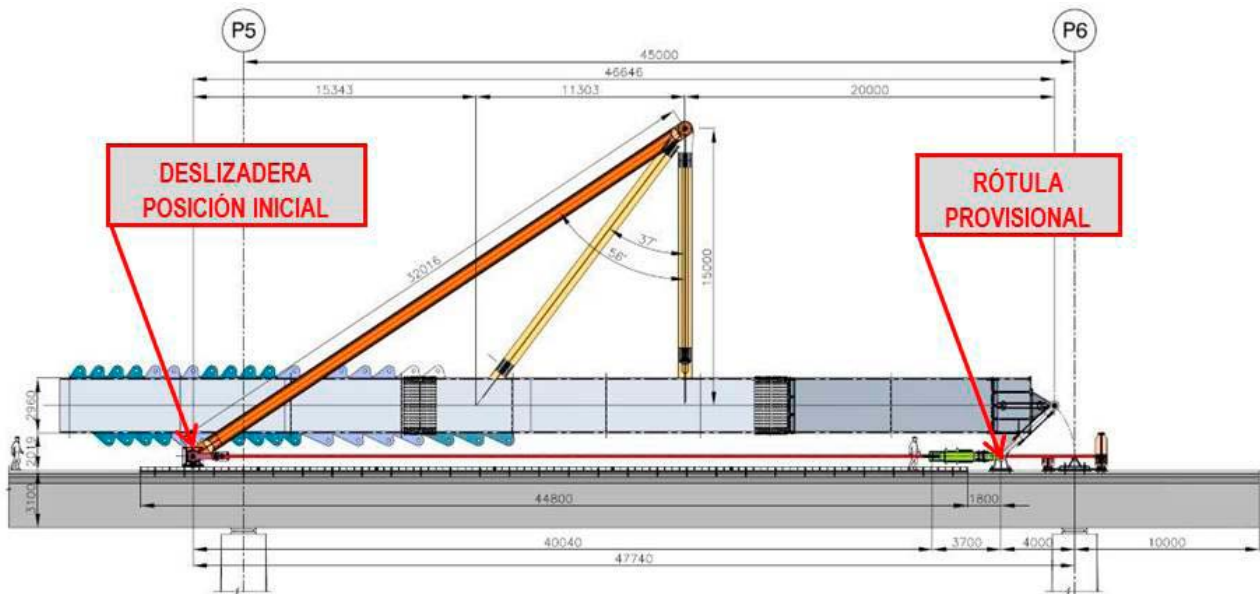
Detalle torre en posición horizontal preparada para el inicio de la operación.
